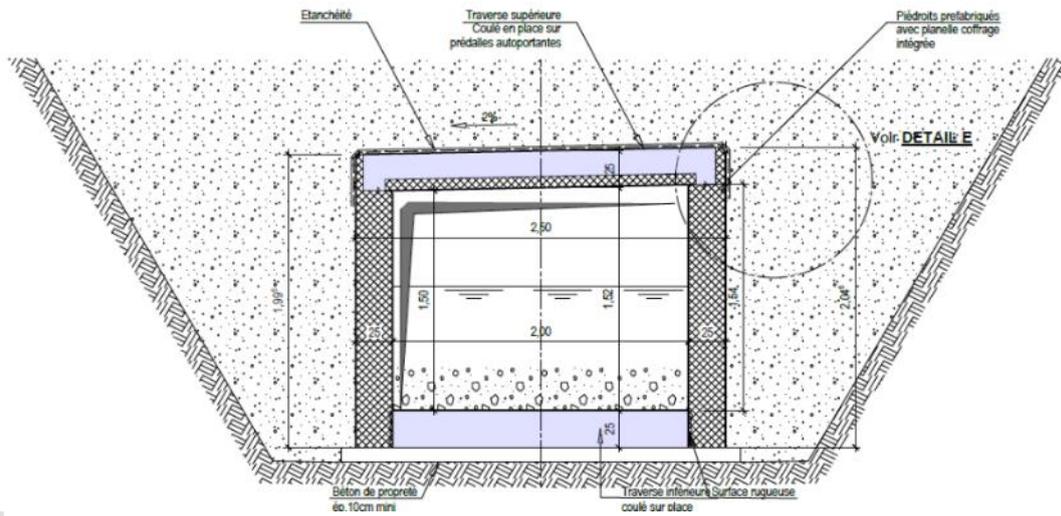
Coupe transversale de l'OA Lertzbach au droit du boulevard de l'Europe (Source : Tertio, 2017)
